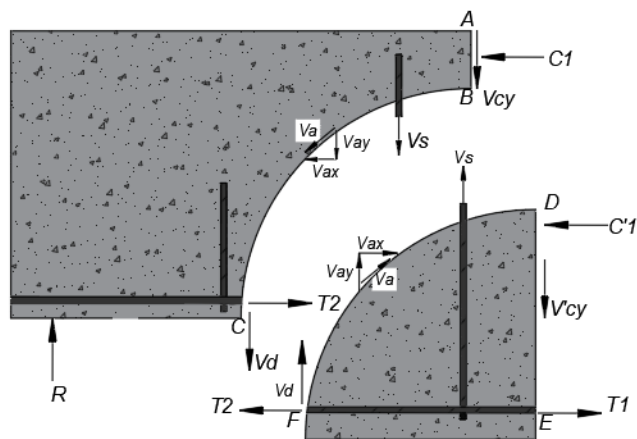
Comportamento de vigas de concreto armado com armadura de cisalhamento (Adaptado de WIGHT e MACGREGOR, 2012)
